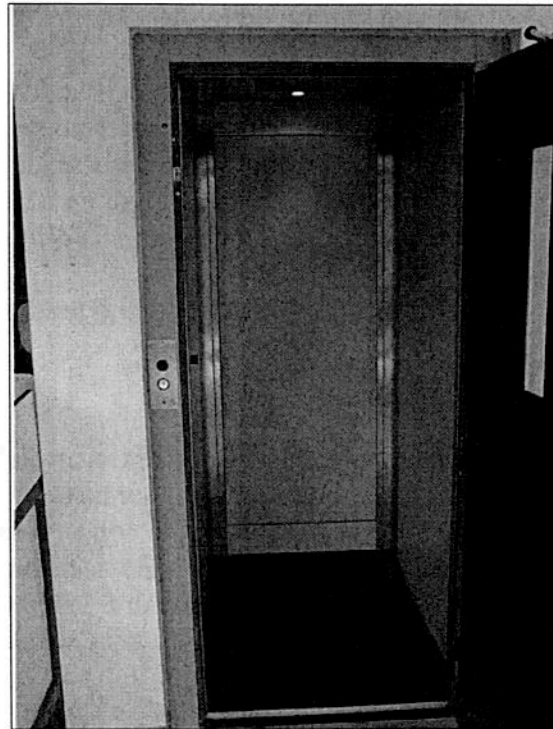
piano T, bene B1, montacarichi collegante bene B1 con bene B3 nel piano S1
